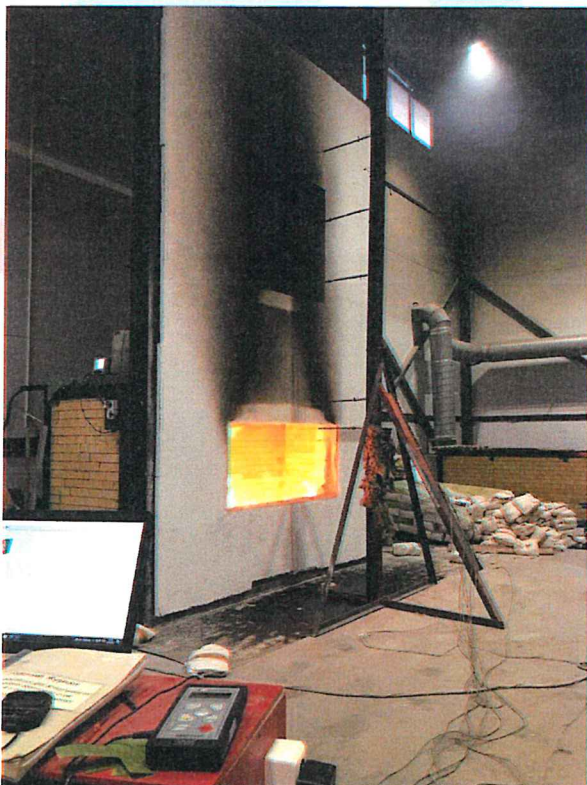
Внешний вид образца на 40-й минуте испытания.
